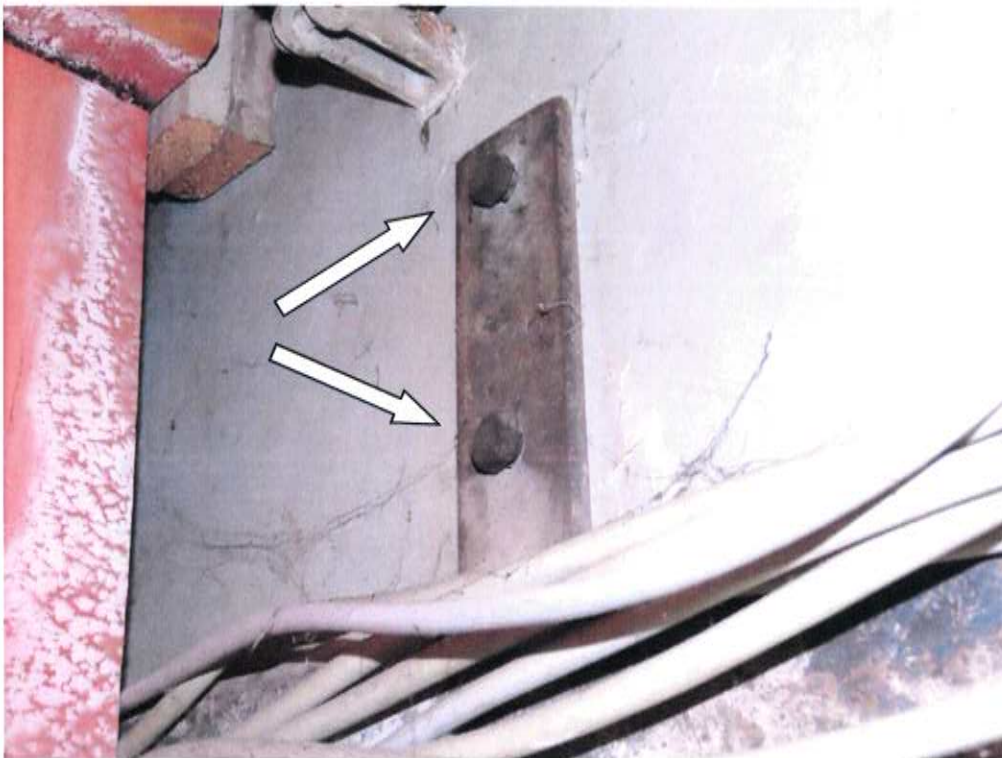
stählernes Lagerprofil: unsachgemäße Aufhängung an Wand (Schraubenköpfe mit Abstand)
